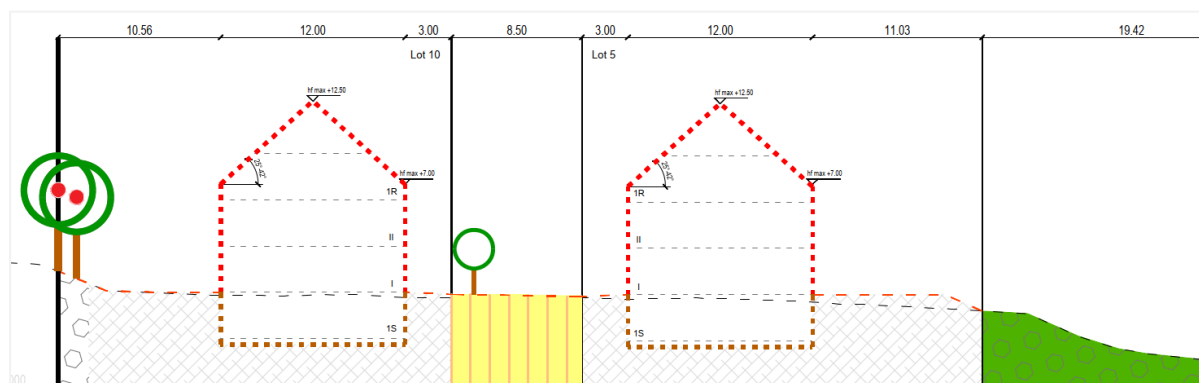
Coupe-type des maisons projetées (Source: BEST)
